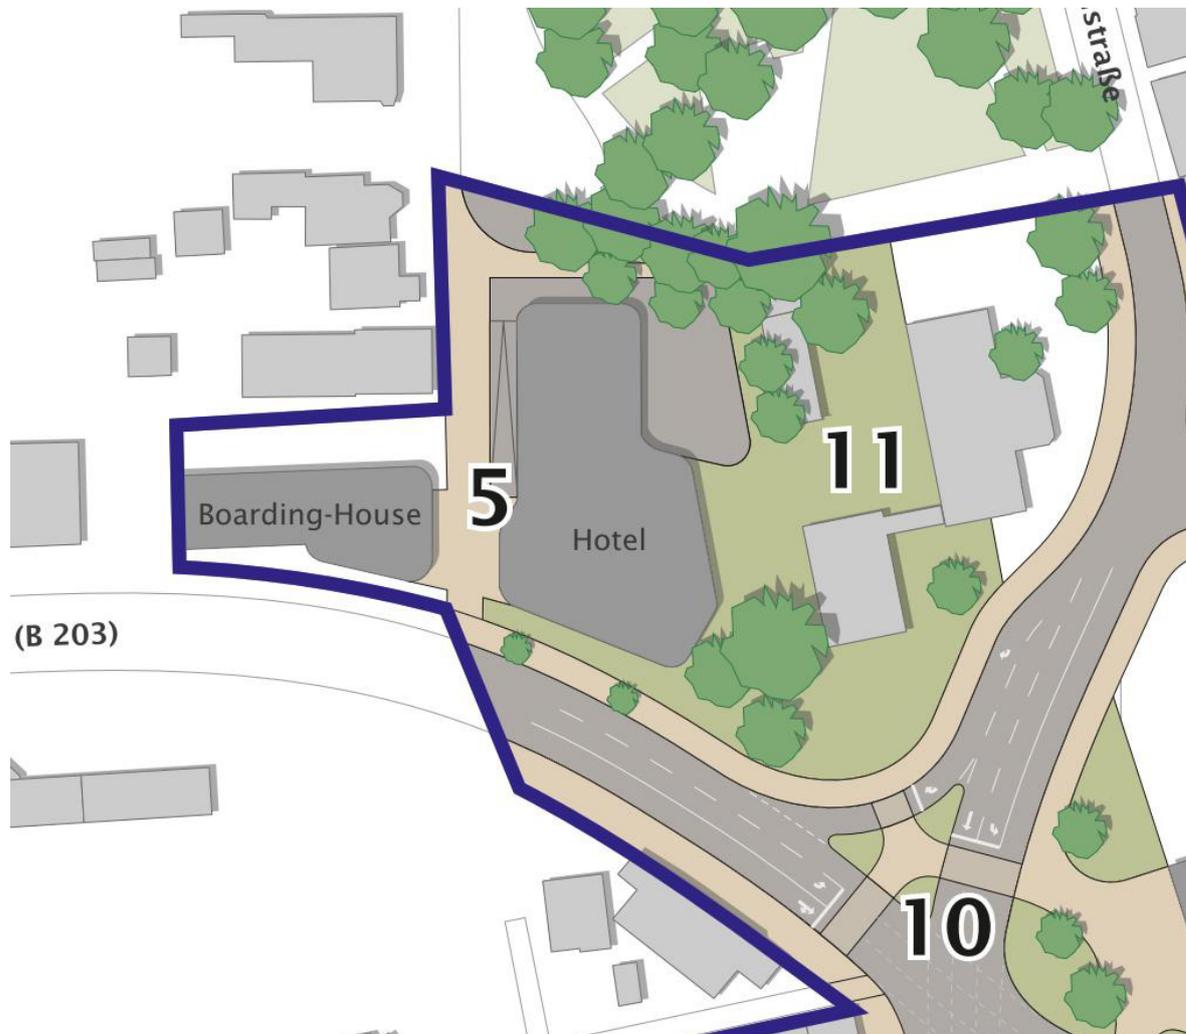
Ausschnitt Teilplan Gestaltung für den Neubau einer Hotelanlage
